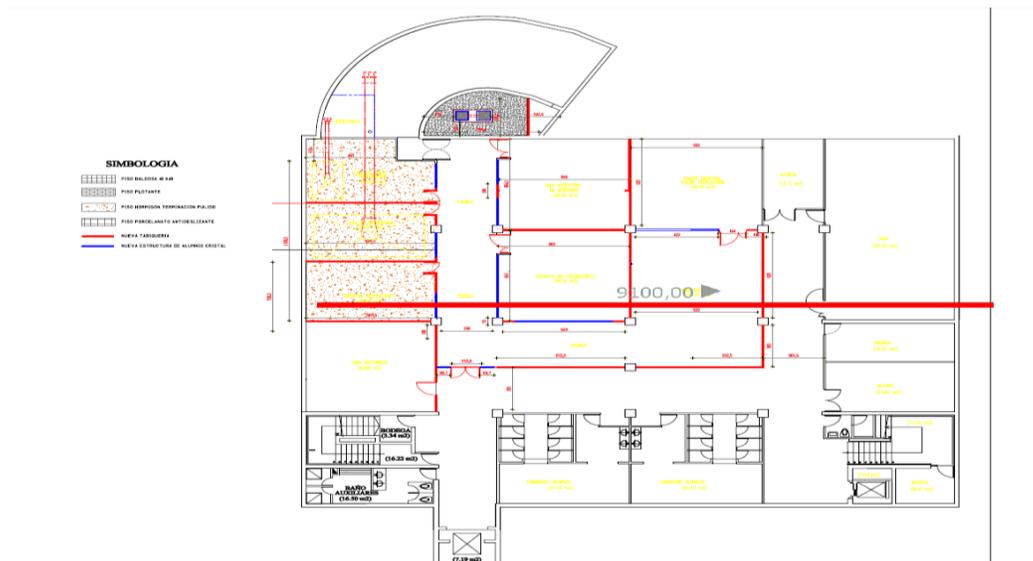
Planos del Laboratorio de Minería UDLA.
